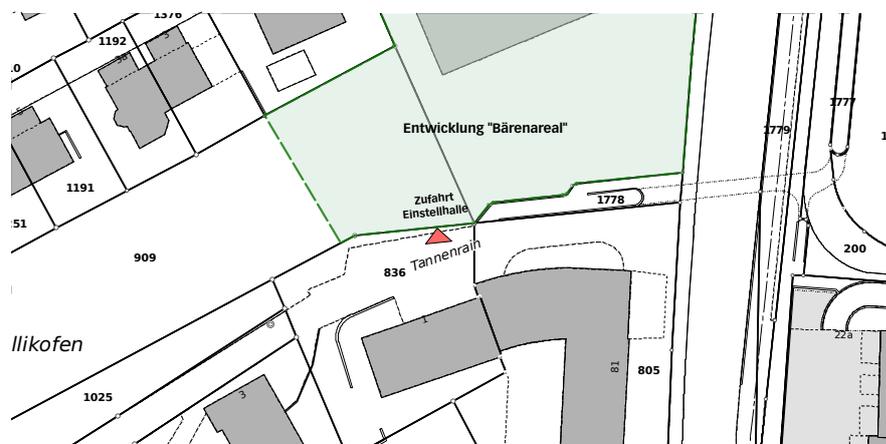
Situationsplan (amtliche Vermessung) mit dem Standort der Einstellhalle-Zufahrt zum Bärenareal (rot)
